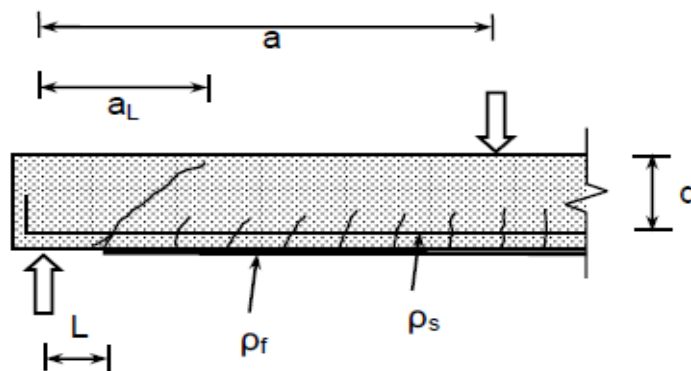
Esquema de fendilhação por corte na zona de ligação
